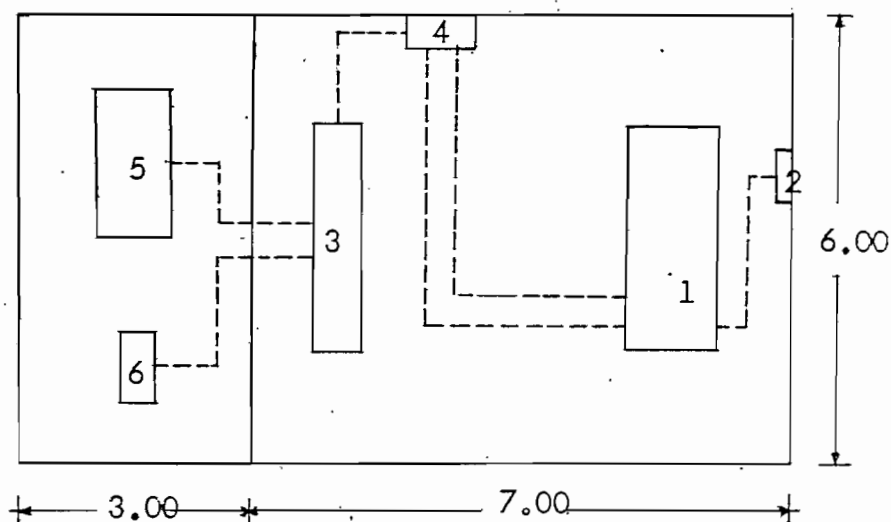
PLANTA DE SUB-ESTACION DE LLEGADA
